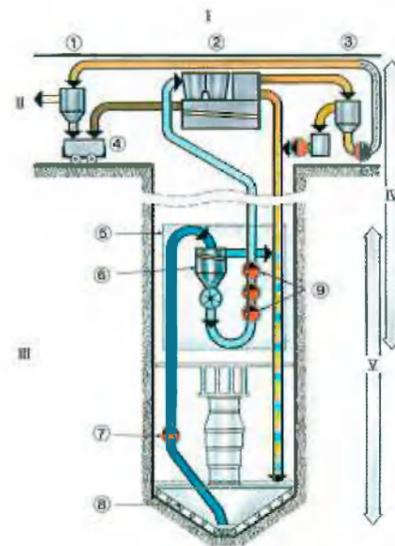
Hydraulische, zweistufige Bohrgutförderung im Bereich des Blindschacht-Anschlags und stationäre Bohrtrübe-Aufbereitungsanlage nach Abb. 1.
